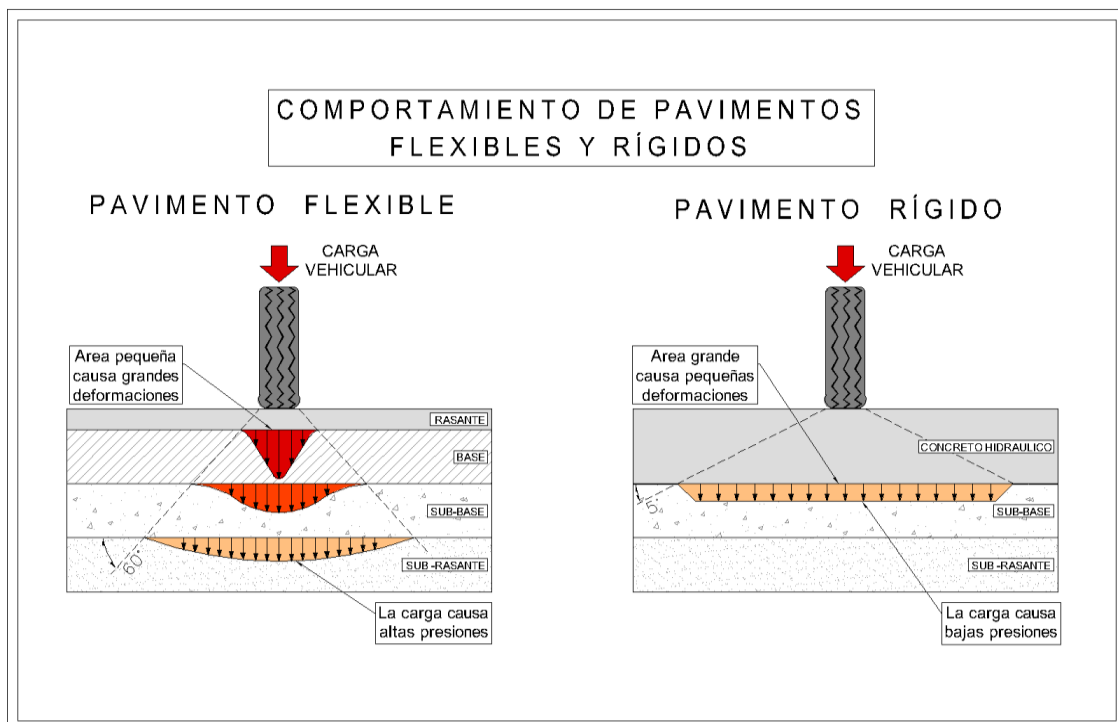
Comportamiento de Pavimentos Flexibles y Rígidos.
